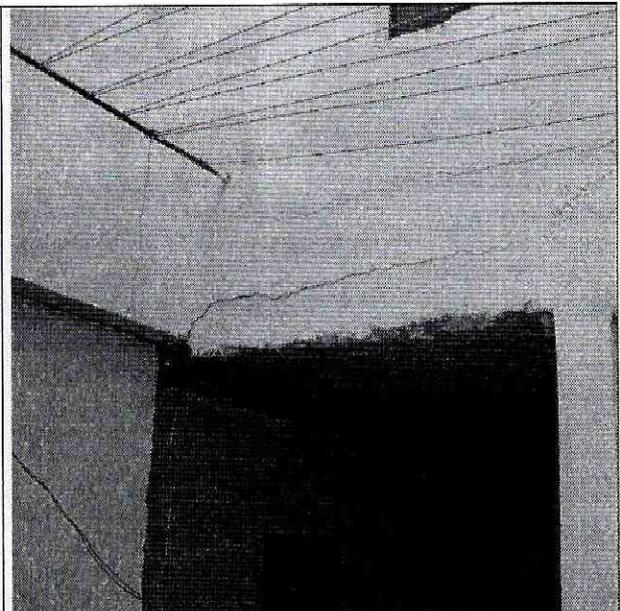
Vista interior del muro de cerramiento del predio de la Carrera 1A # 100 – 35 Sur. Se observa la separación, deriva ó pérdida de verticalidad experimentada por el muro y la columna. Adicionalmente se observa que la grieta de tracción perteneciente al proceso de inestabilidad es la responsable de la separación entre el muro y la columna.
